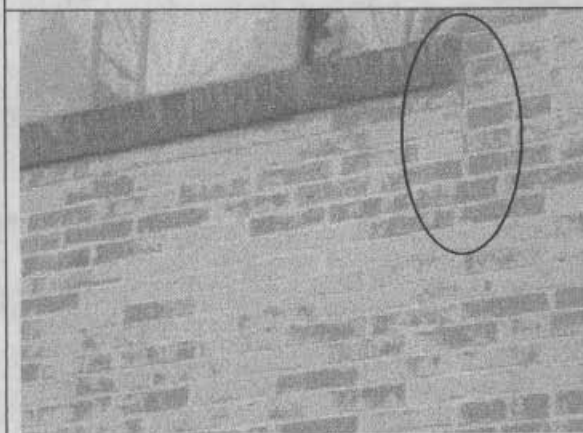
Fisura vertical en la mampostería a la altura de la ventana.
